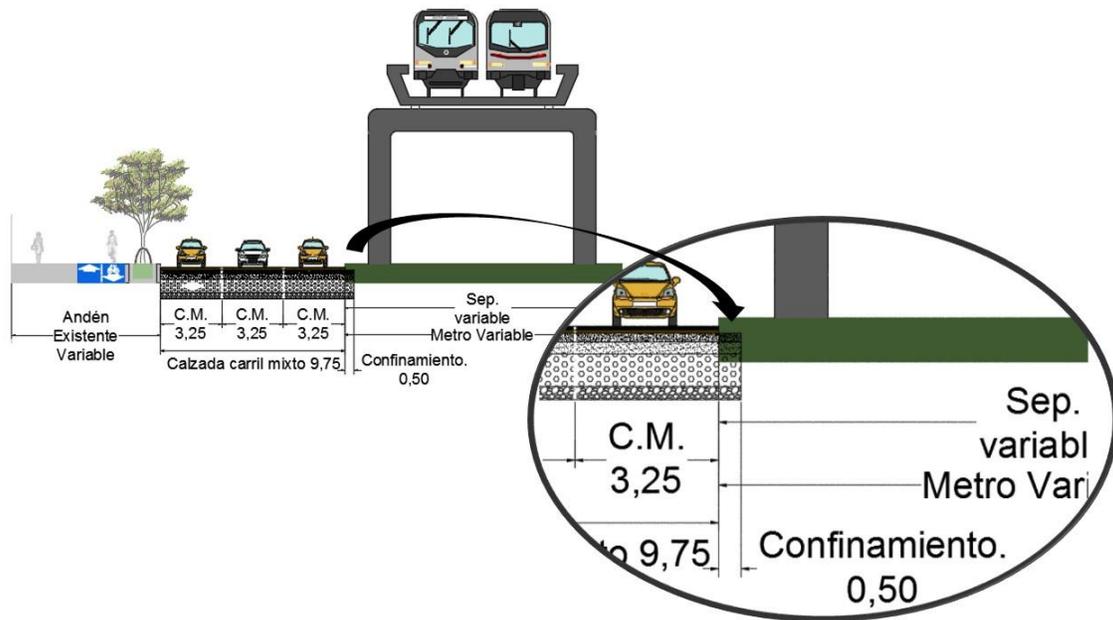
Esquema de disposición de la zona de confinamiento del pavimento
